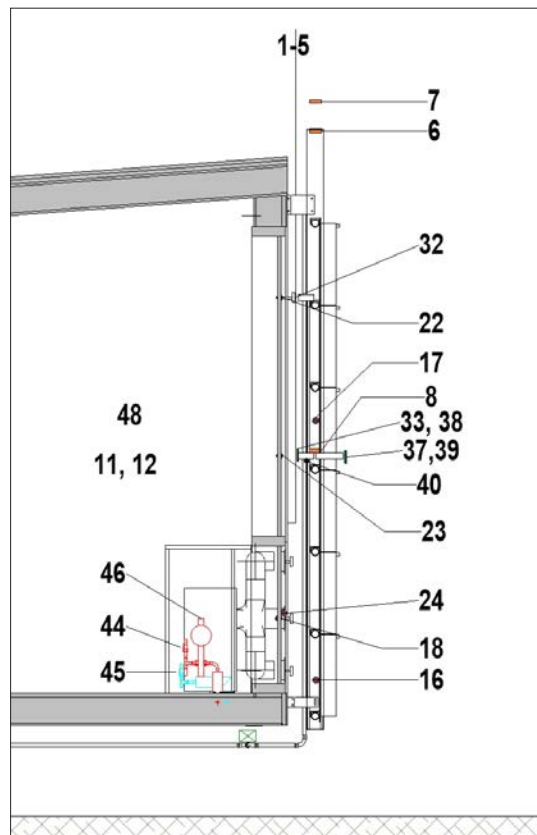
Fassadenversuchsstand – Lage Sensoren begrünt. Vertikalschnitt (o. M.) (THN-AR) (Legende vgl. Tab. A5 und A6 im Appendix)
